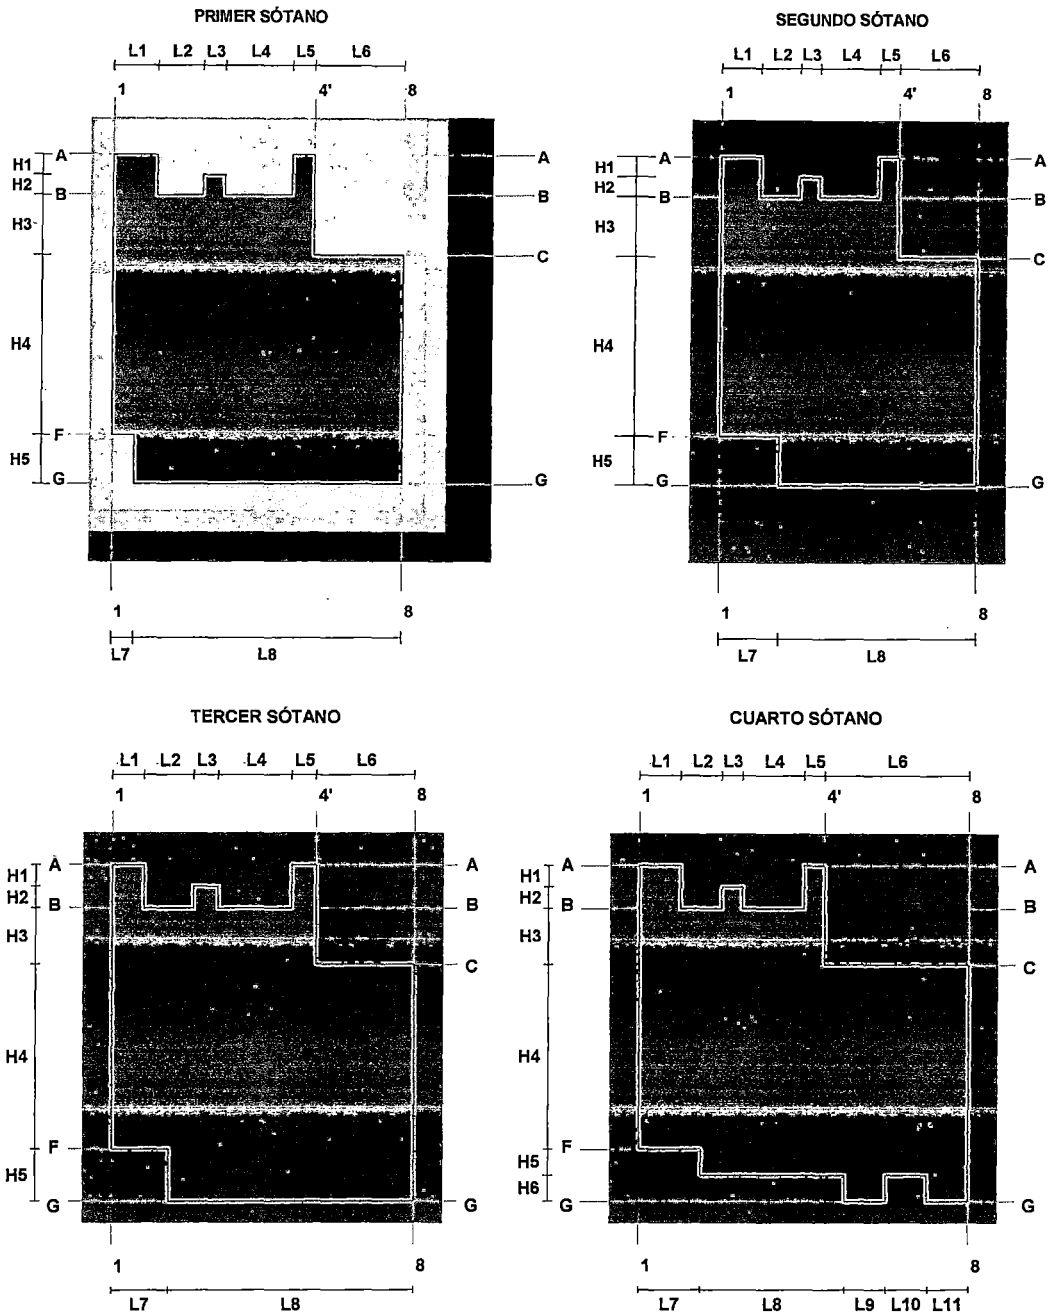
Esquema de plantas de sótano de NEO 10 (Elaborado por el autor)
